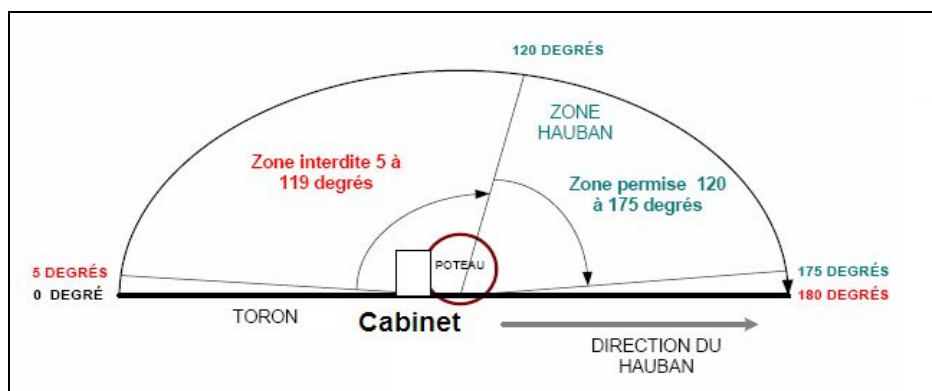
Installation d'un cabinet sur un poteau avec hauban
